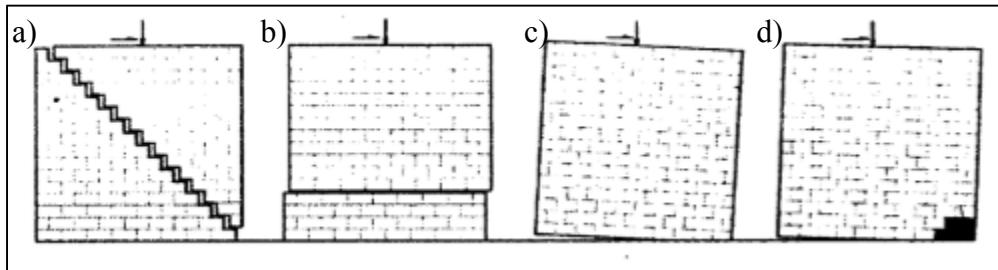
Modes de rupture en plan d'un mur en MNA : a) Traction diagonale, b) Glissement, c) Balancement et d) Écrasement
